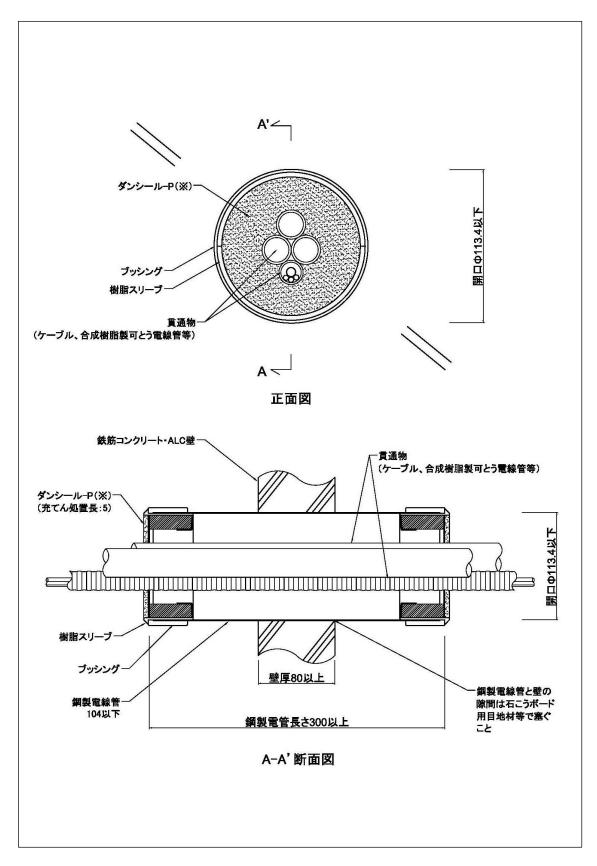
プチロクワイド 標準施工図(鋼製電線管貫通、鉄筋コンクリート・ALC 壁)
